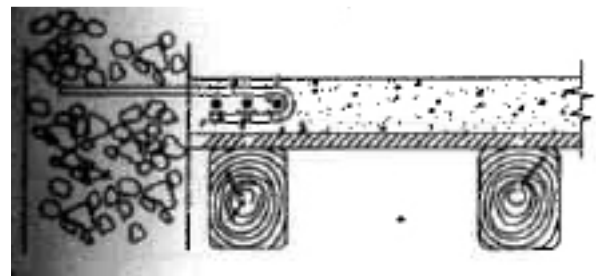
Ligação do bordo lateral do piso madeira-betão (Piazza, 2008).
